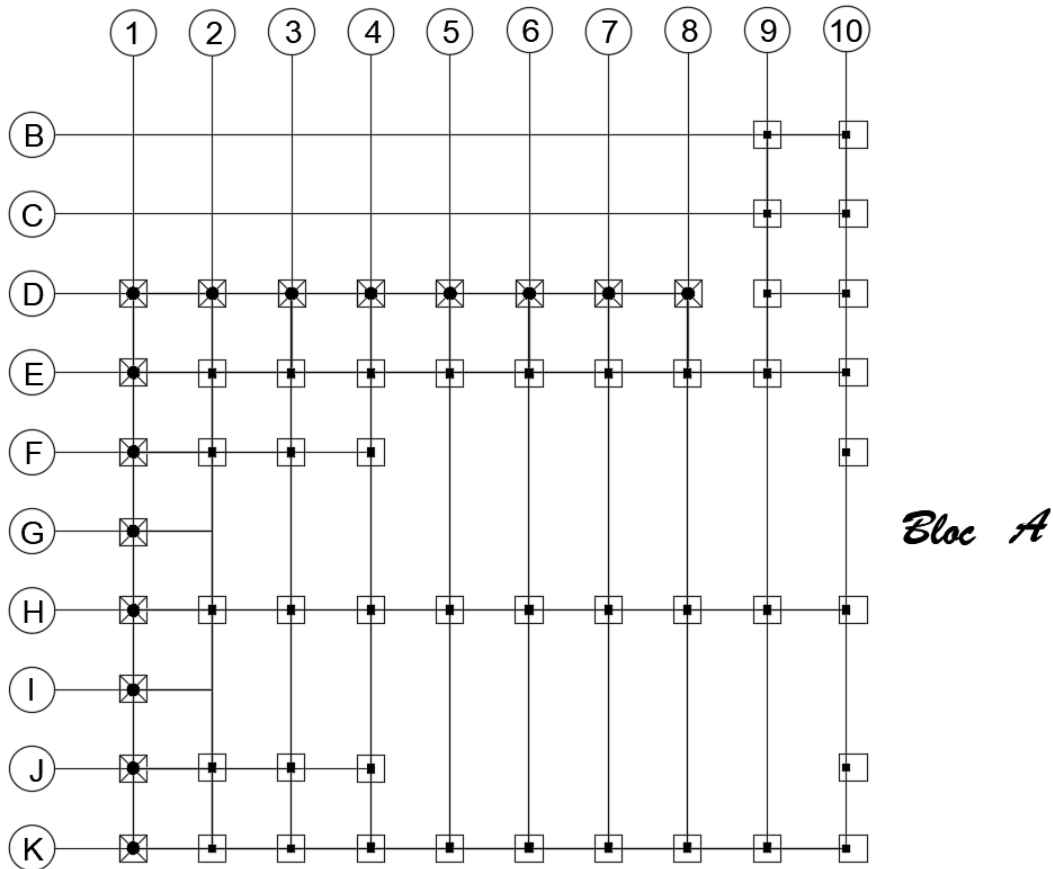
plan du fondation de bloc étudiée (bloc A)
